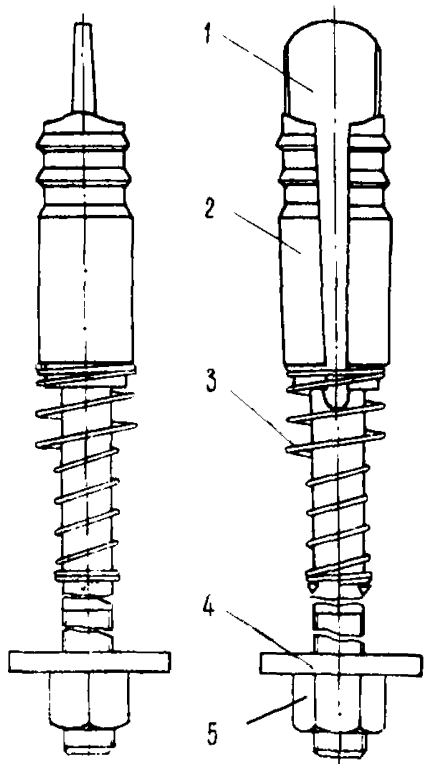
Металлический самозаклинивающийся анкер ШК-3:
